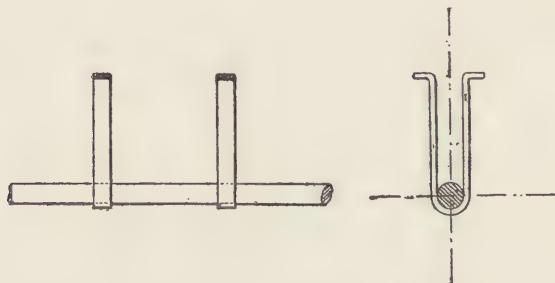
Disposition des étriers dans les poutres Hennebique.
